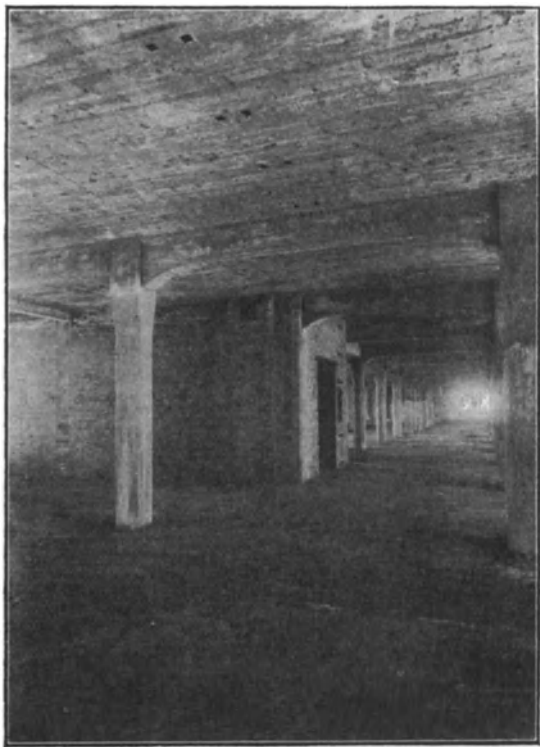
Fertige Eisenbetondecke mit Holzdübeln und Durchführungsrohren.
